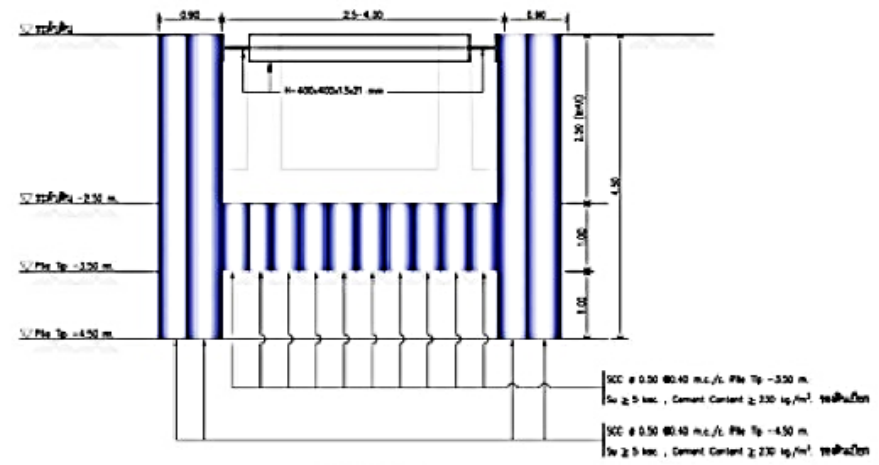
แบบ Typical กำแพงกันน้ำ CASE 4 และ Detail Expansion Joint
